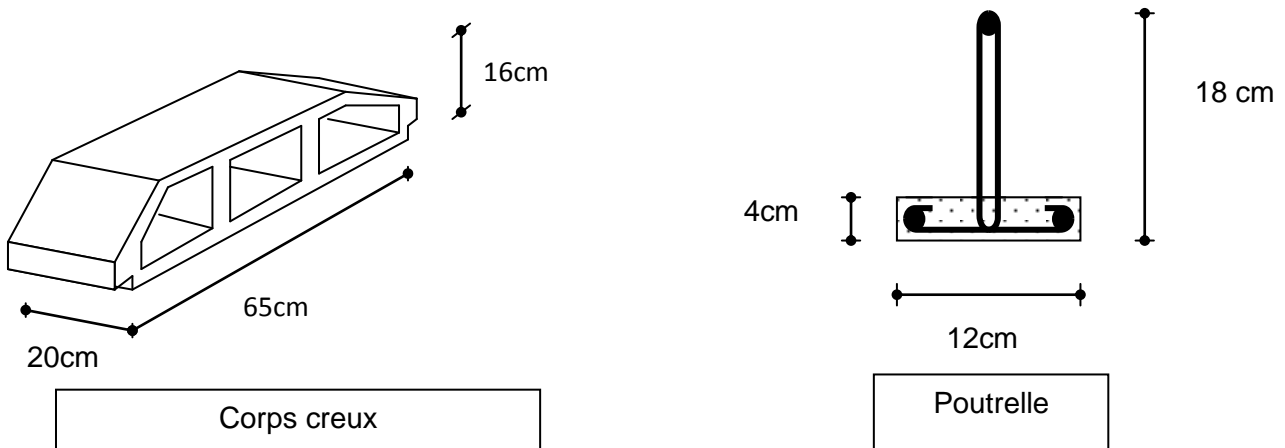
Coupe verticale sur un plancher en corps creux
